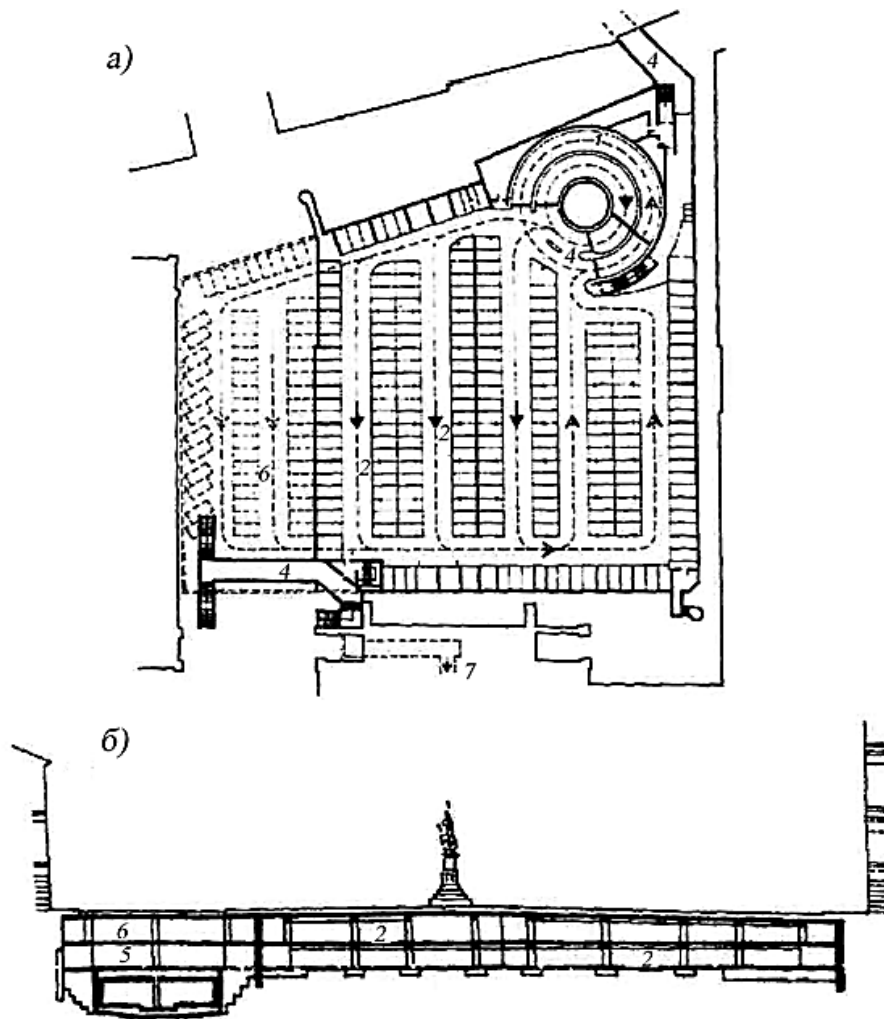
Двоярусний підземний гараж на Макс-Йозефплац у Мюнхені, Німеччина: (а – план, б – розріз): 1 – пандуси в'їзду та виїзду; 2 – стоянки автомобілів; 3 – контроль, каса; 4 – підземні переходи; 5 – проєктована станція метрополітену; 6 – друга черга будівництва гаража; 7 – будівля Національного театру
